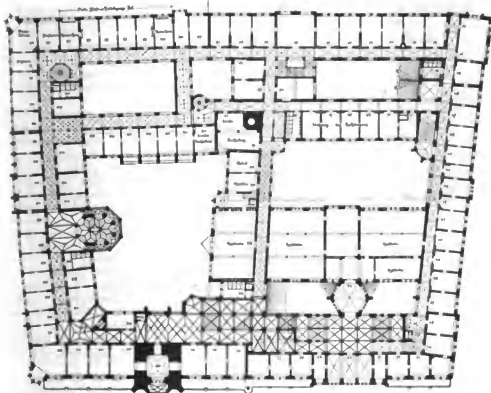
Grundriss vom I. Obergeschoss. — Masstab 1 : 800.
